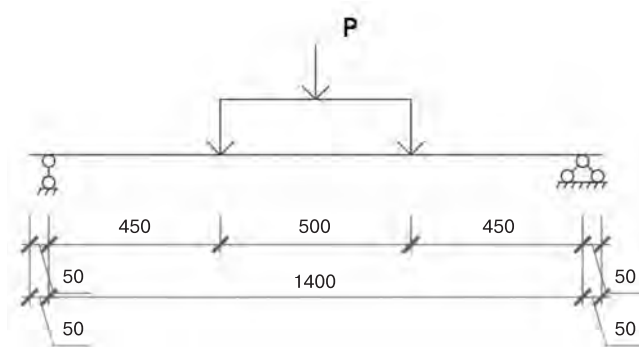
Схема испытаний партий образцов с шифрами 1.1-1; 1.1-3; 1.2-1 и 1.2-3
